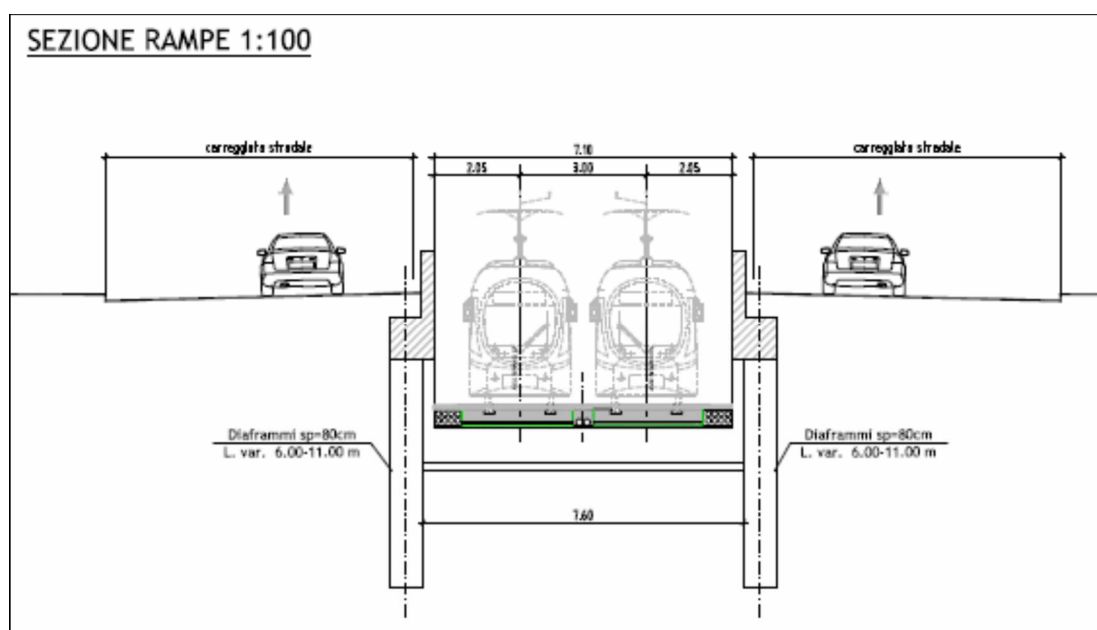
Sezione trasversale rampe di accesso (estratto da elaborato B831-C-SF-STR-RT002A)
